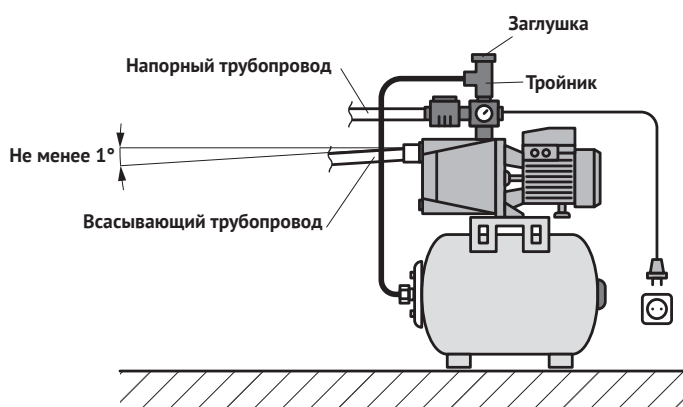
Схема монтажа универсальной насосной станции JSW 55
